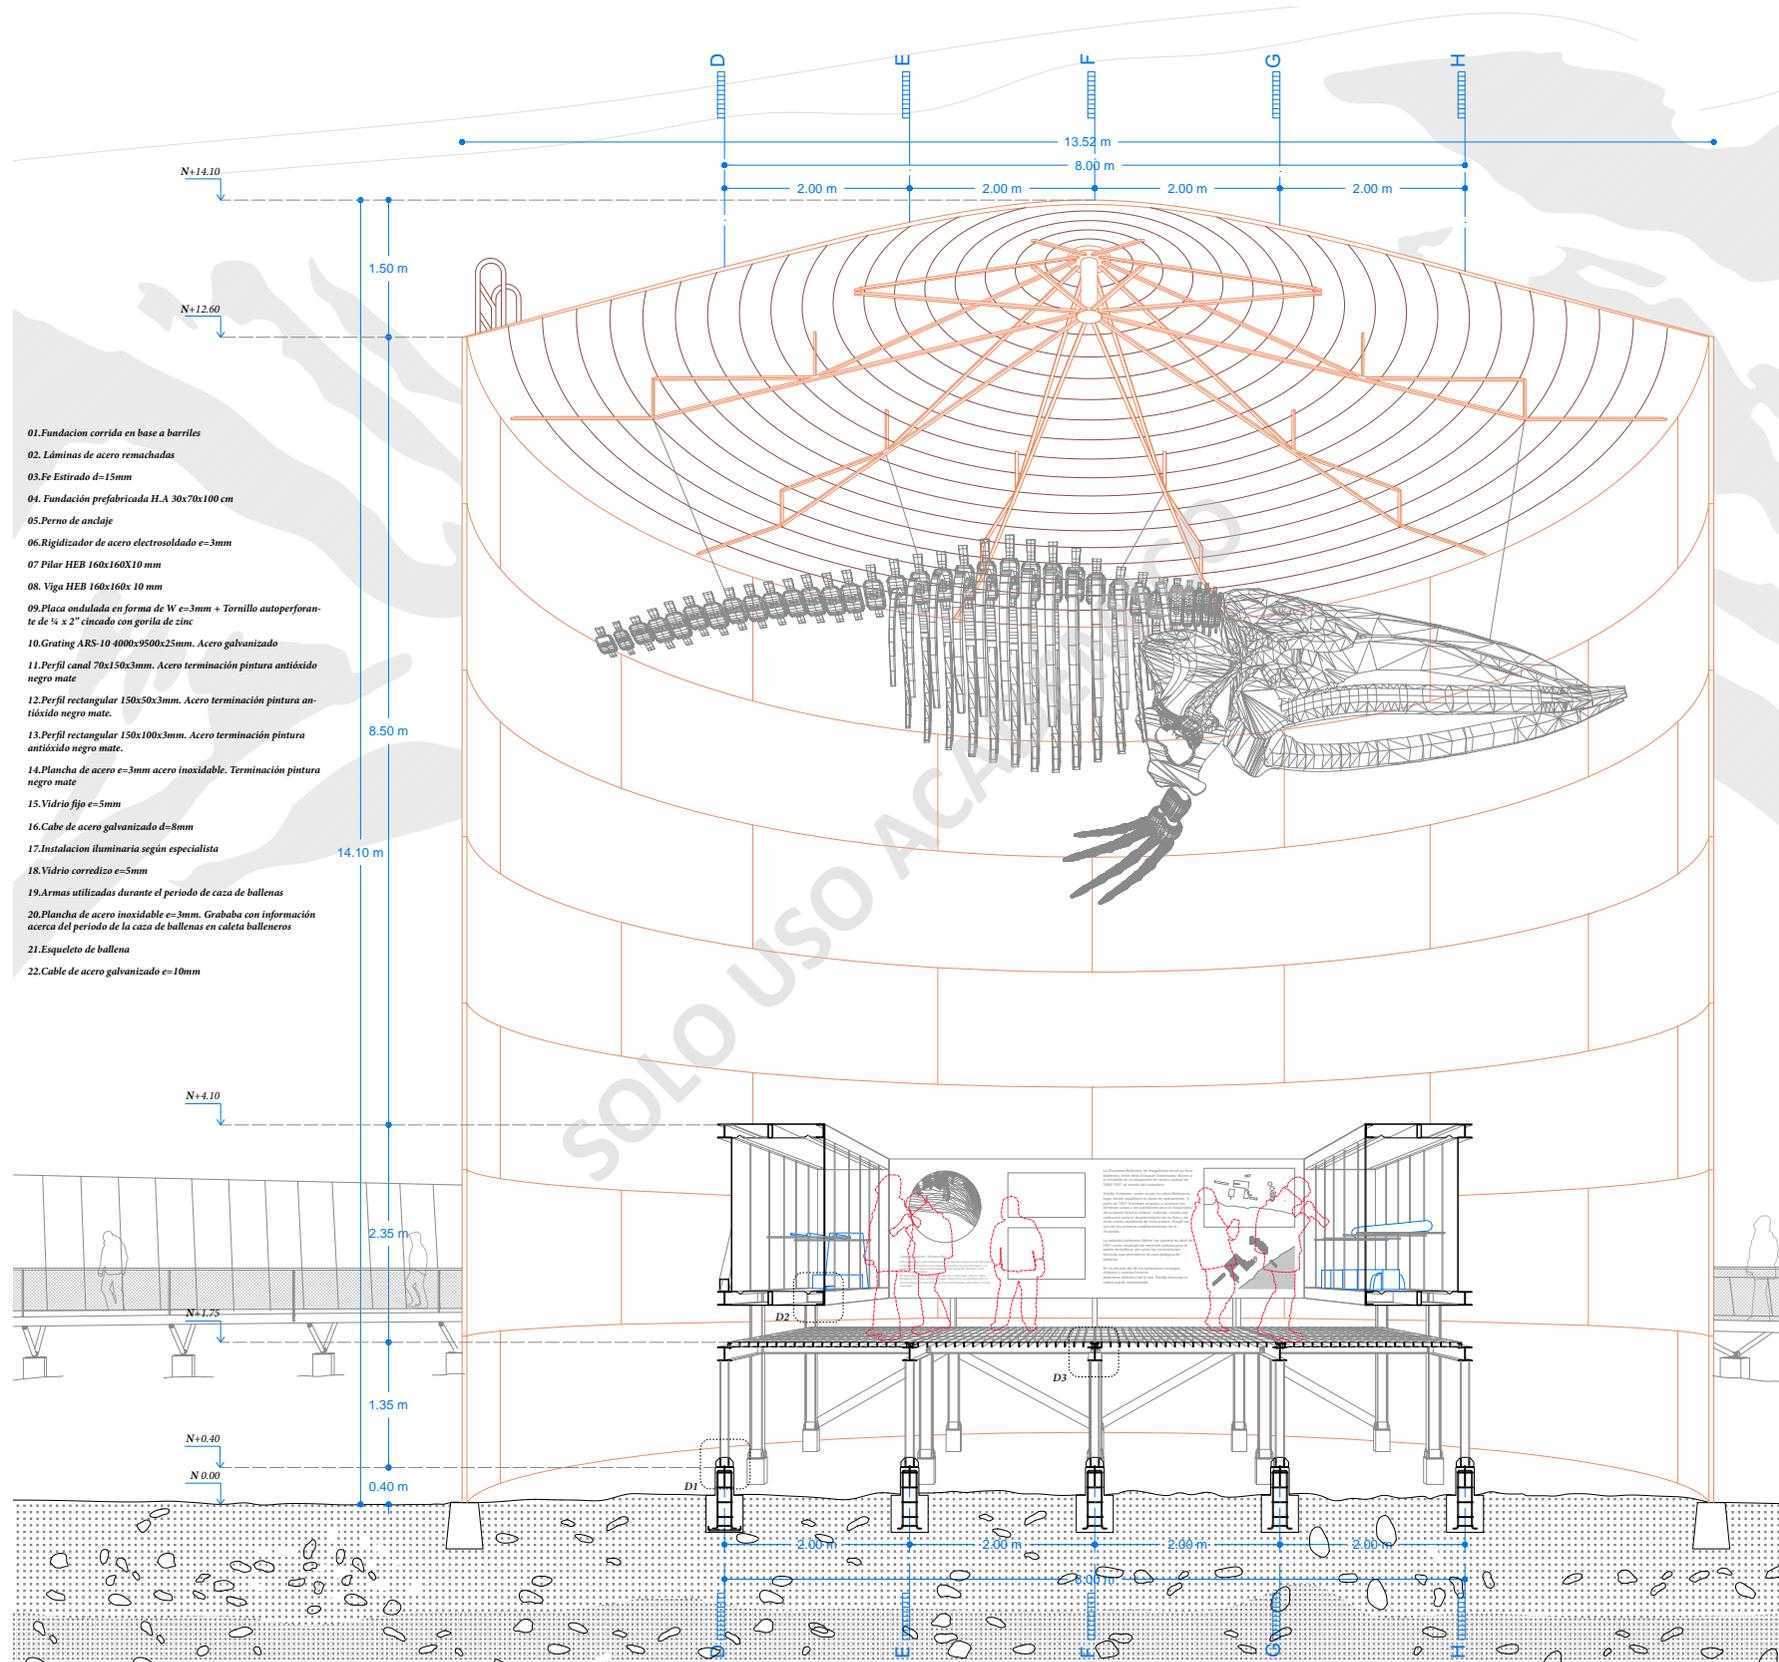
Escantillón Interior proyecto. Fuente: Elaboración propia
